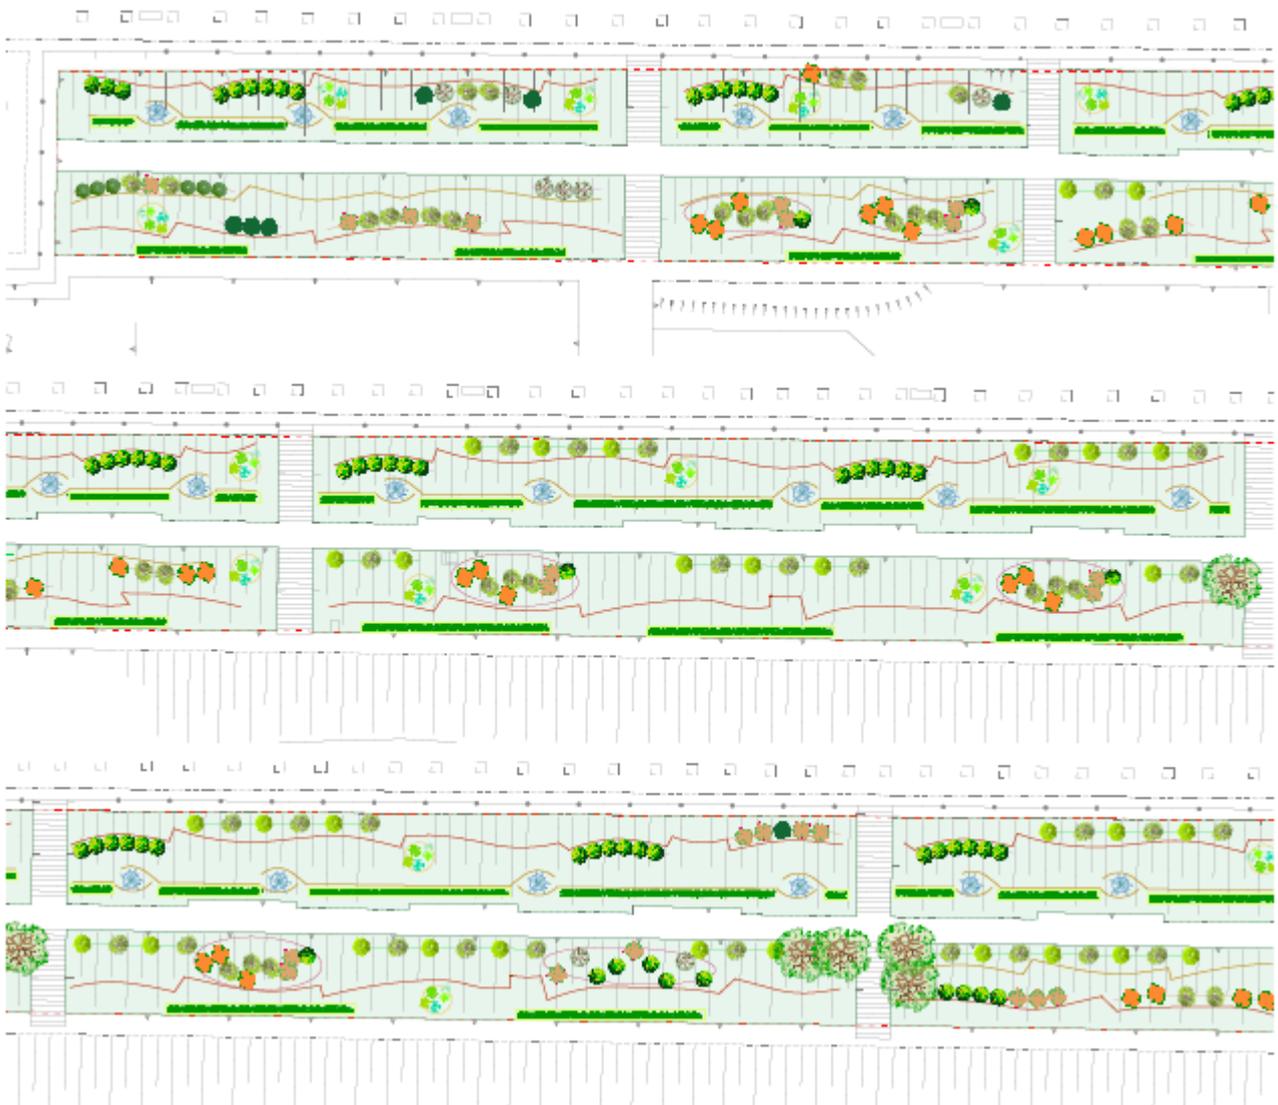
Estratto elaborato Planimetria opere verde (1 di 2)
